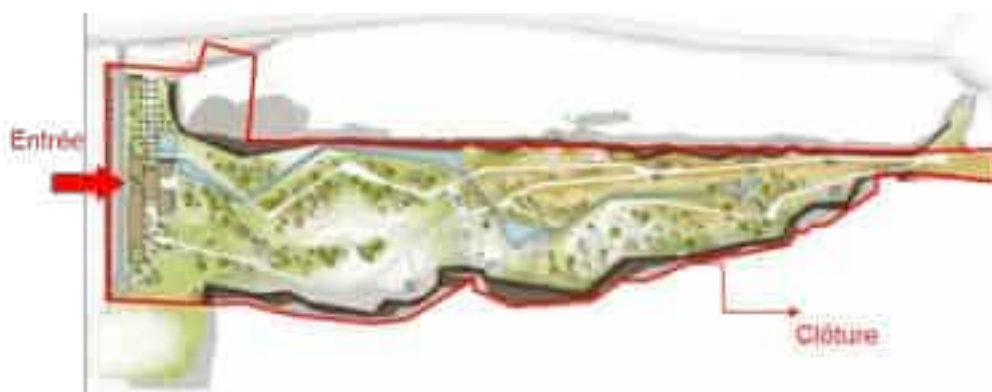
Plan général du projet de parc (Source : document d'architecte (A. GHAZALI))
